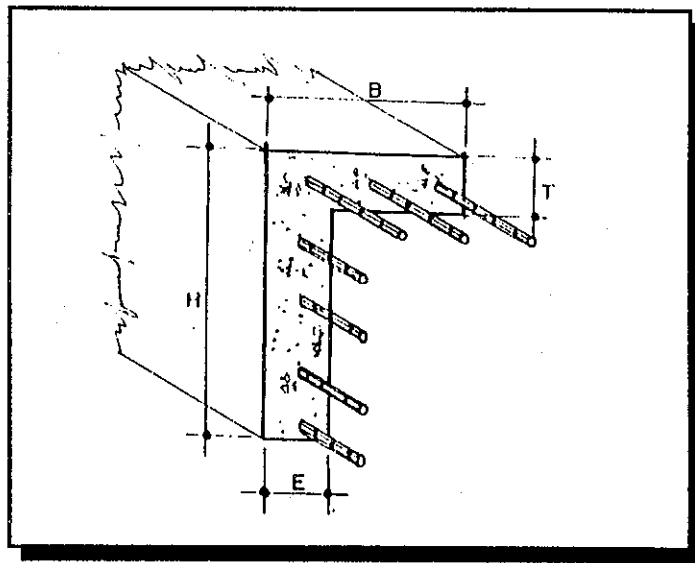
SECCIÓN "L" INVERTIDA DE UNA VIGA DE CONCRETO REFORZADO SOMETIDA A ESFUERZOS DE FLEXION
